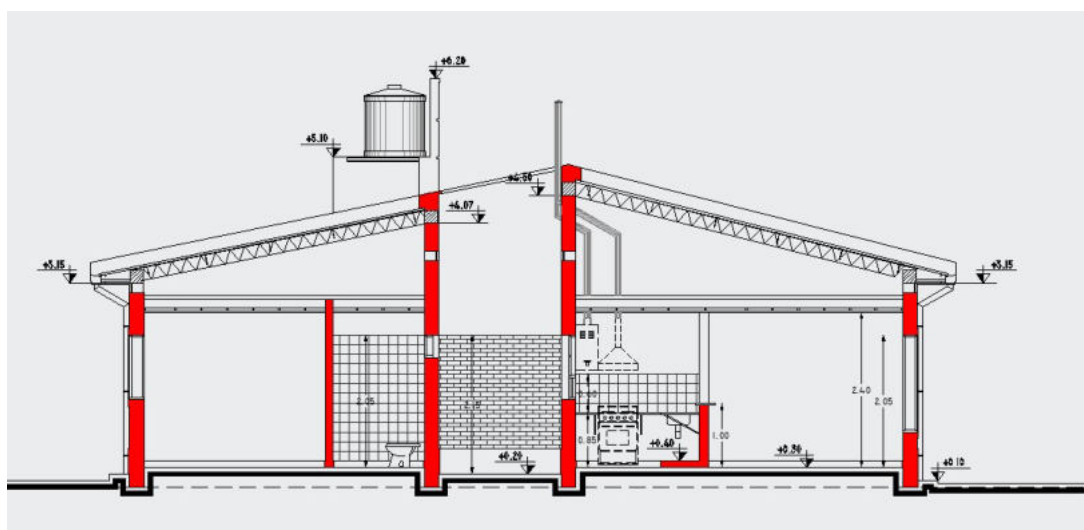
Corte longitudinal de la vivienda – Fuente: Planimetría provista por el propietario
